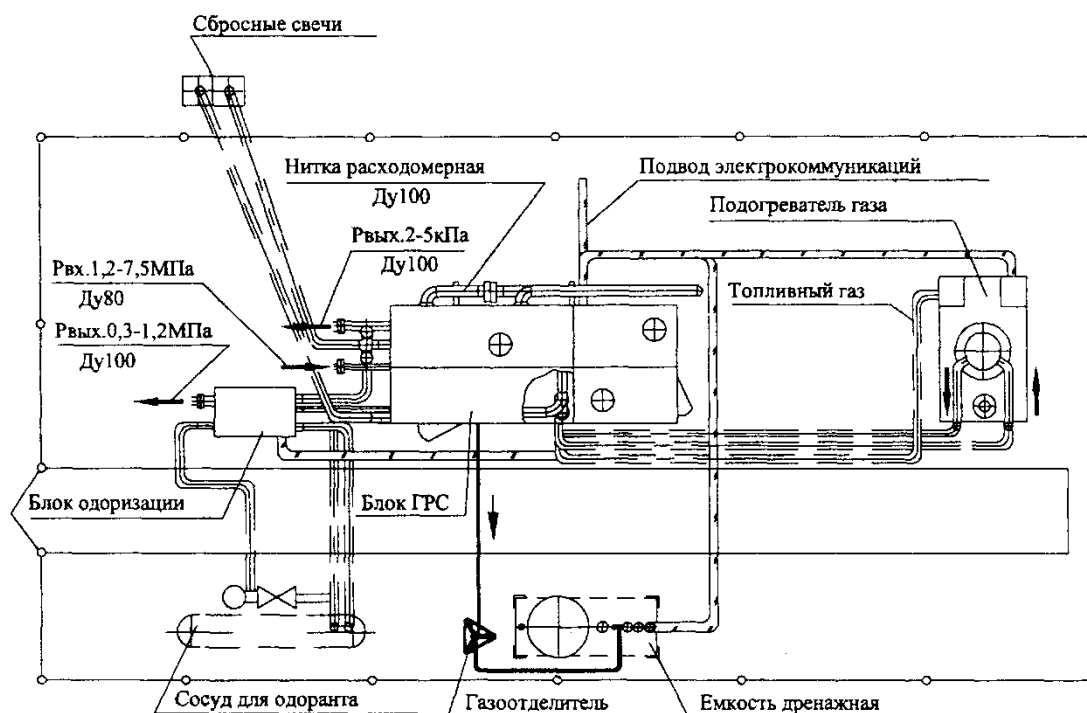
Схема размещения блоков станции "САРАТОВ-5" на площадке
